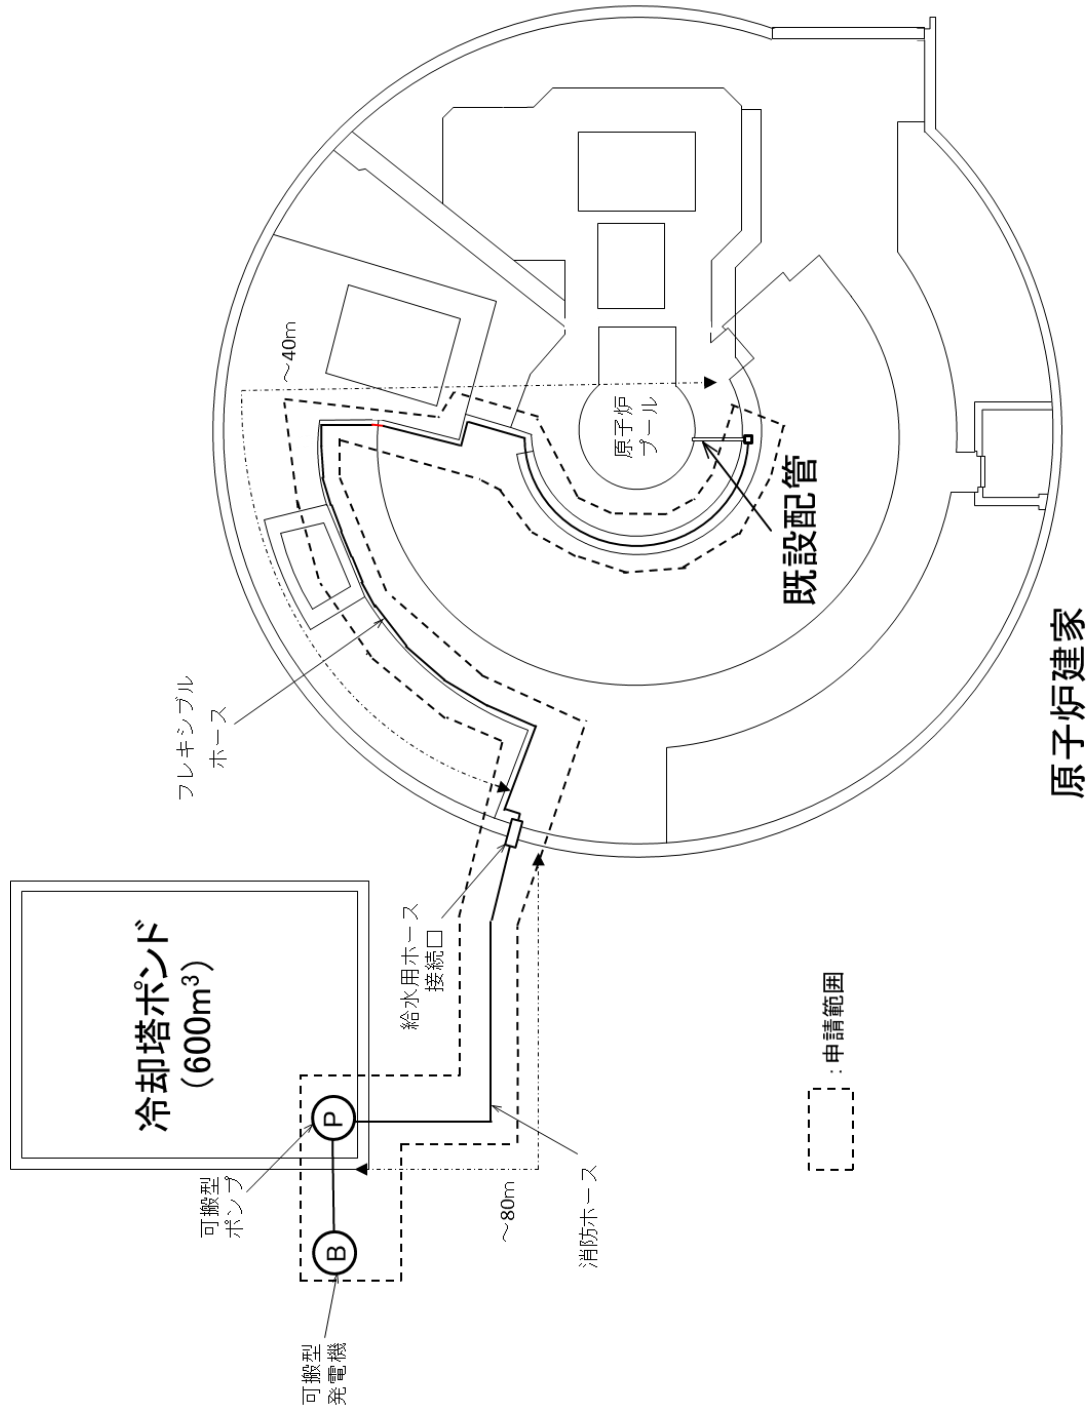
原子炉建家外の冠水維持機能喪失時用給水設備配置イメージ図 (平面図)
